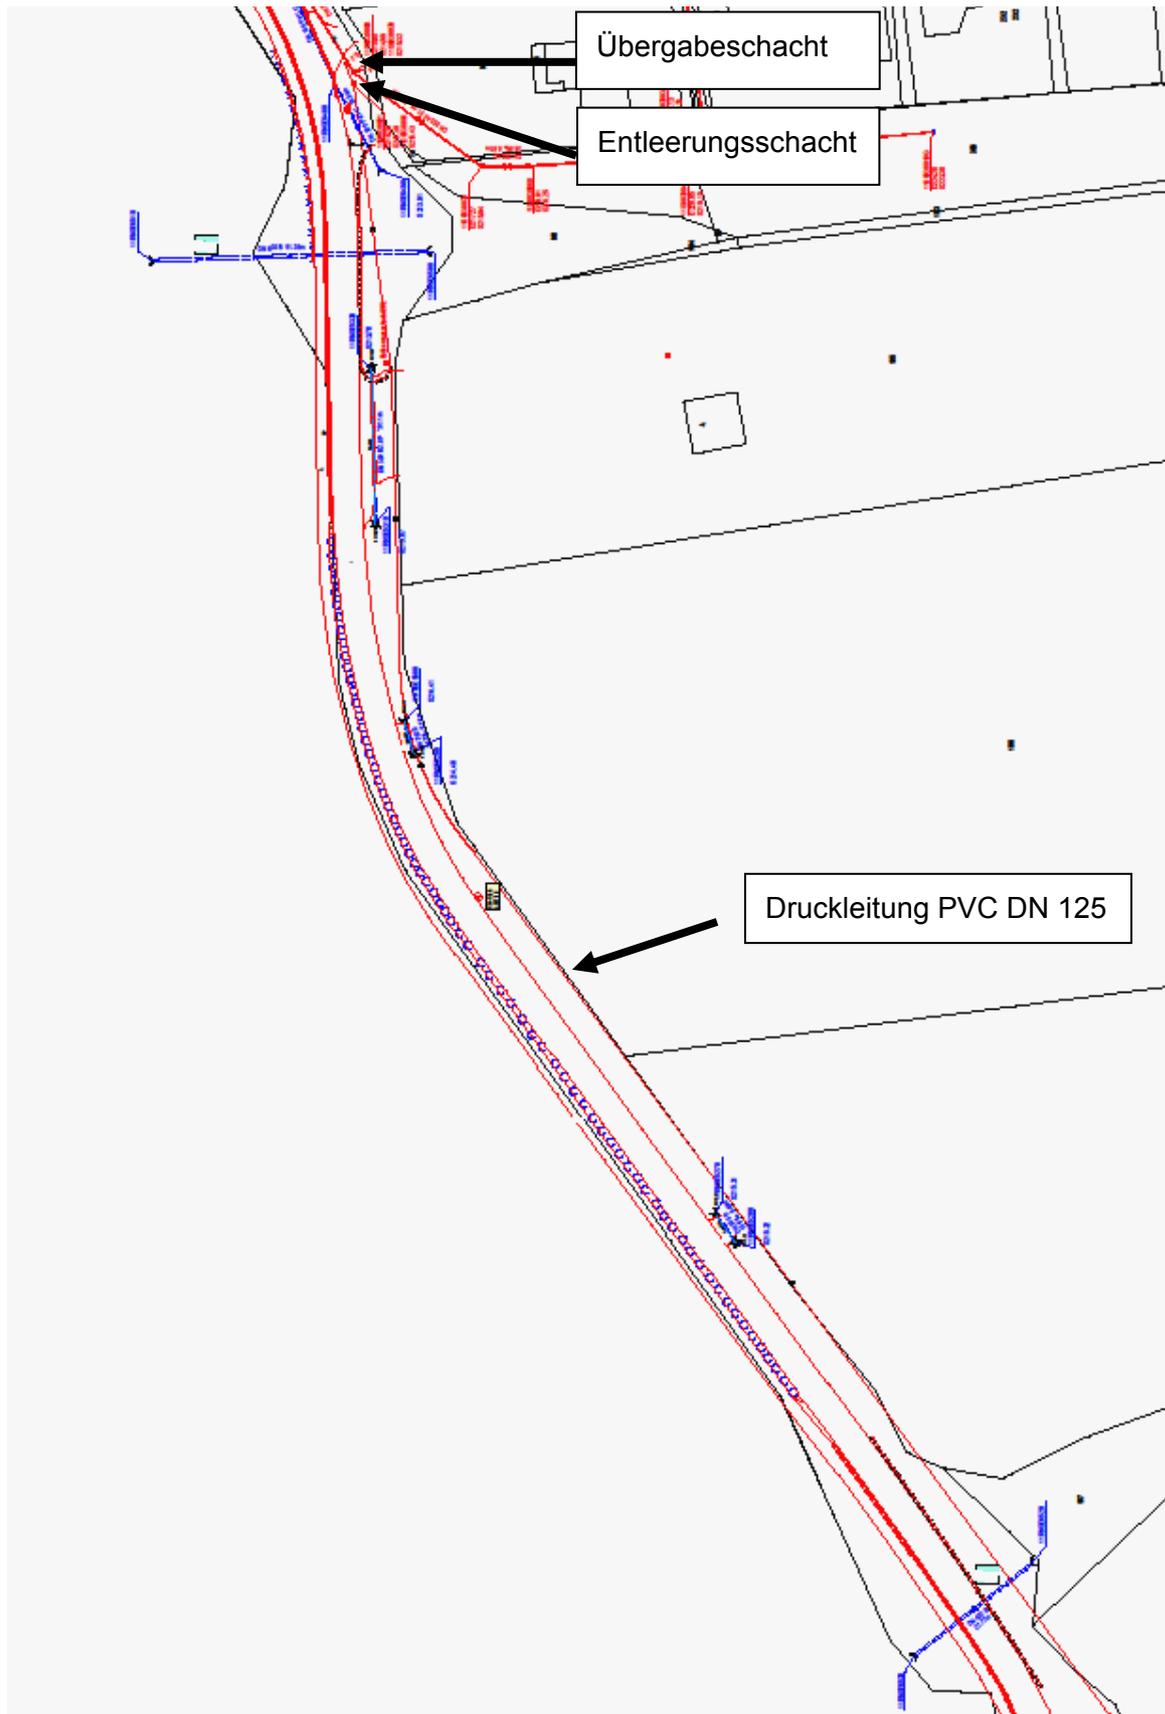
Lageplan Druckleitung DN 125 PVC, Länge ca. 2 km
